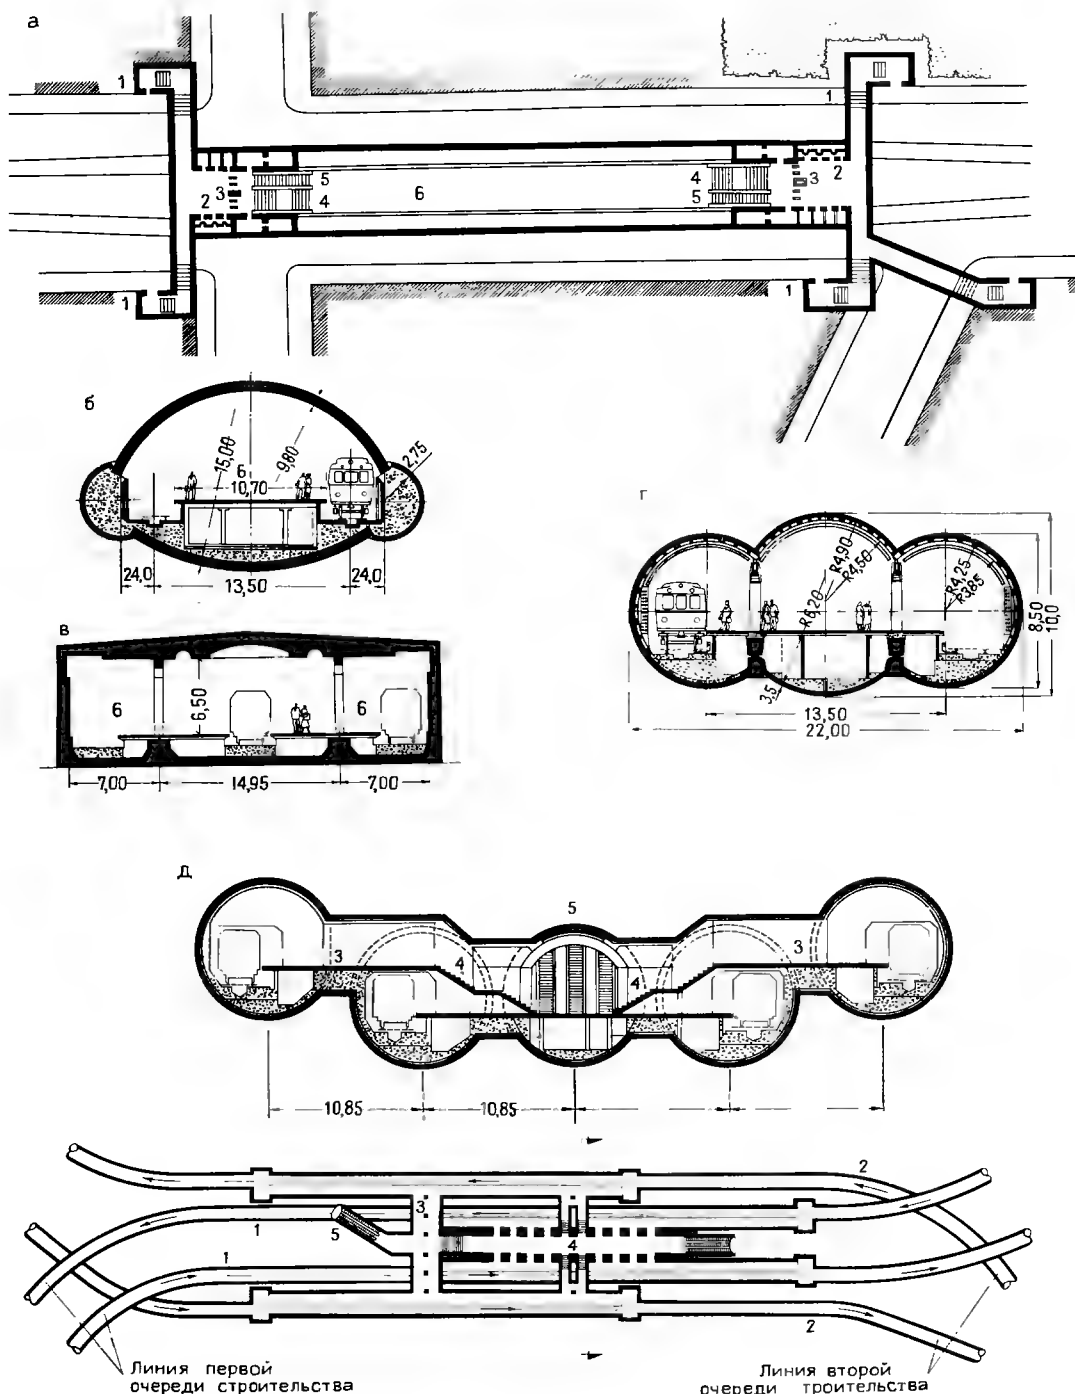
Планировочные схемы и габариты станций и пересадочных узлов метрополитена
